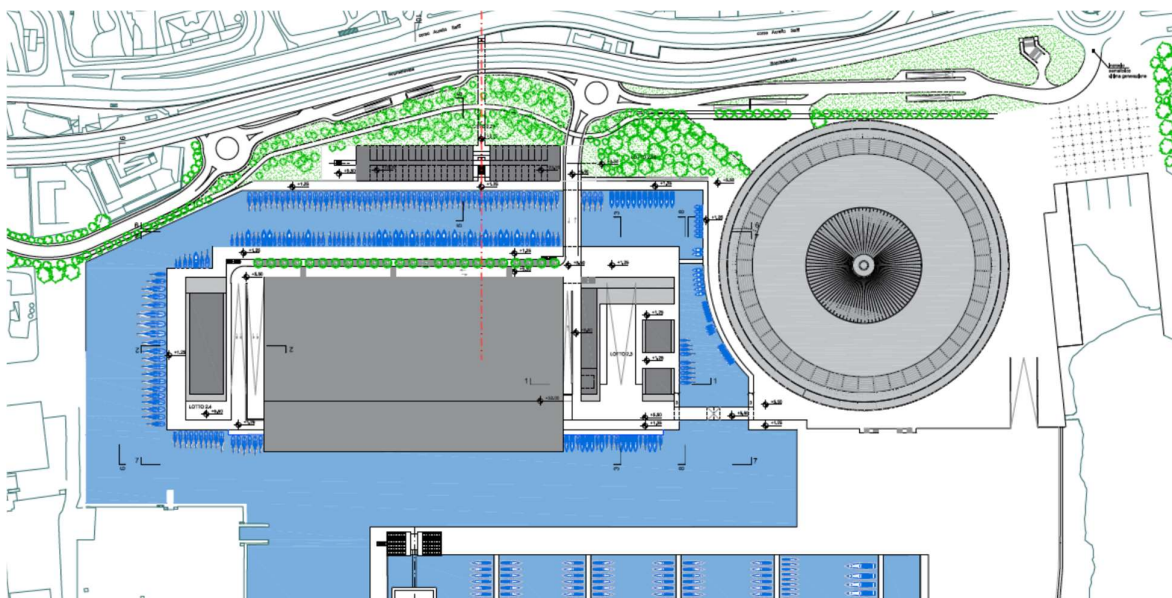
Planimetria di aggiornamento del layout generale del PUO in adempimento alle prescrizioni della Soprintendenza
